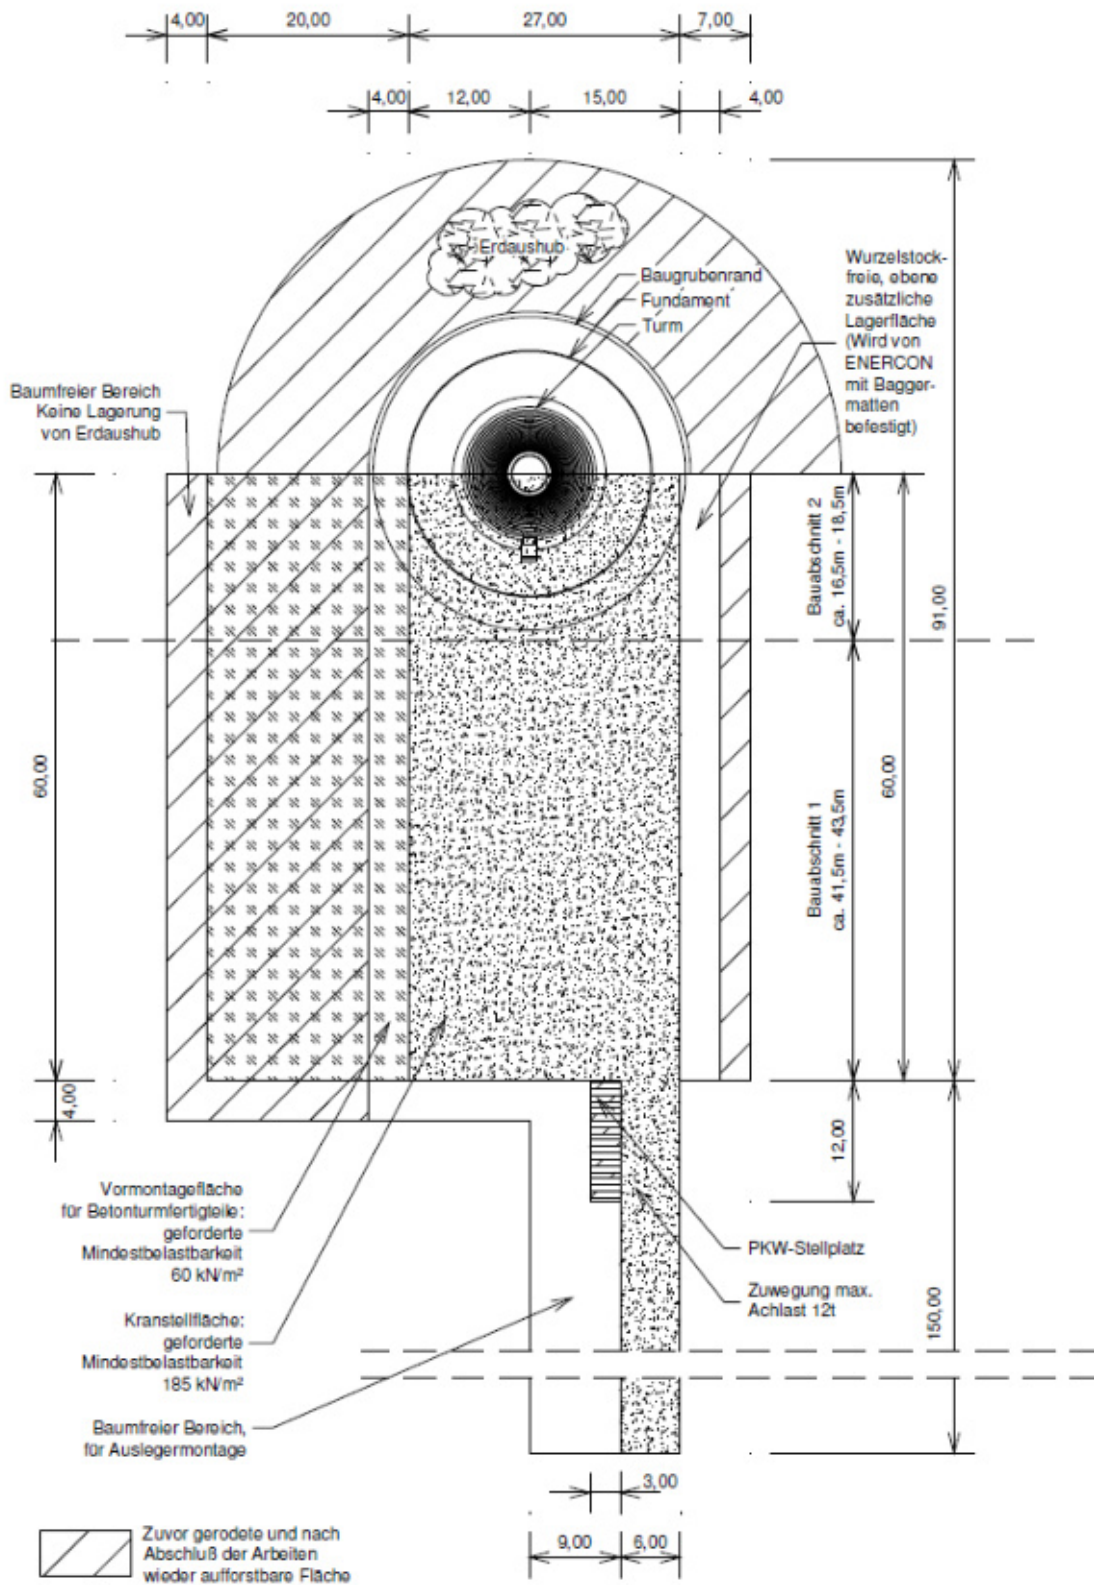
Ausführung der Kranstellfläche einer E-115 mit 147 m Betonfertigteilturm in Waldgebieten nach Enercon (2014)
